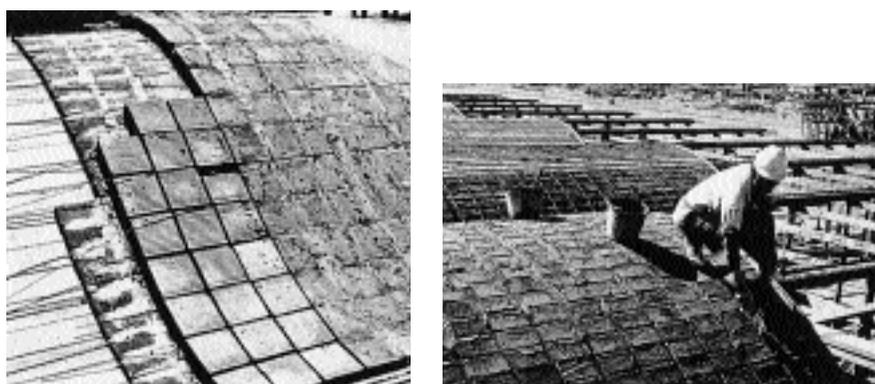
Construcción de cubiertas laminares de cerámica armada.
